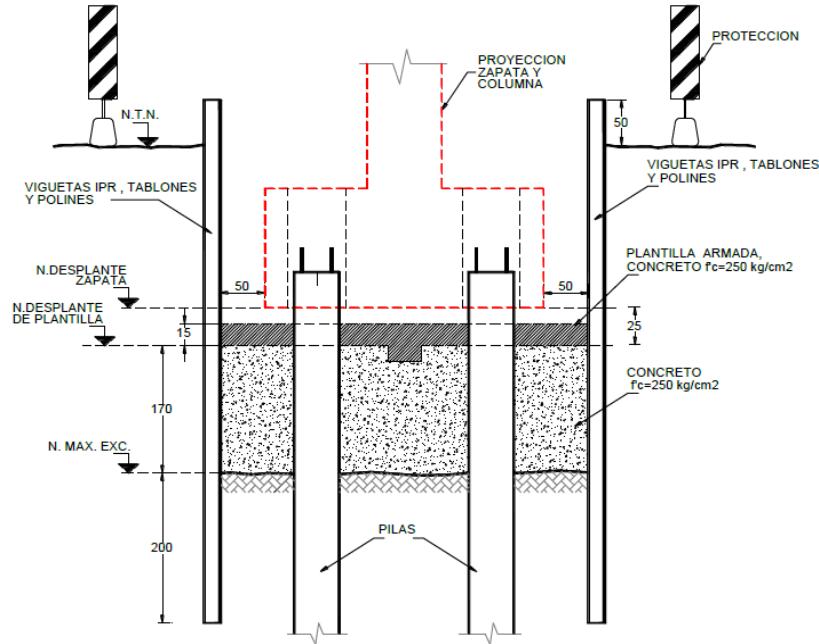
Mejoramiento en concreto, plantilla y ubicación de la zapata
